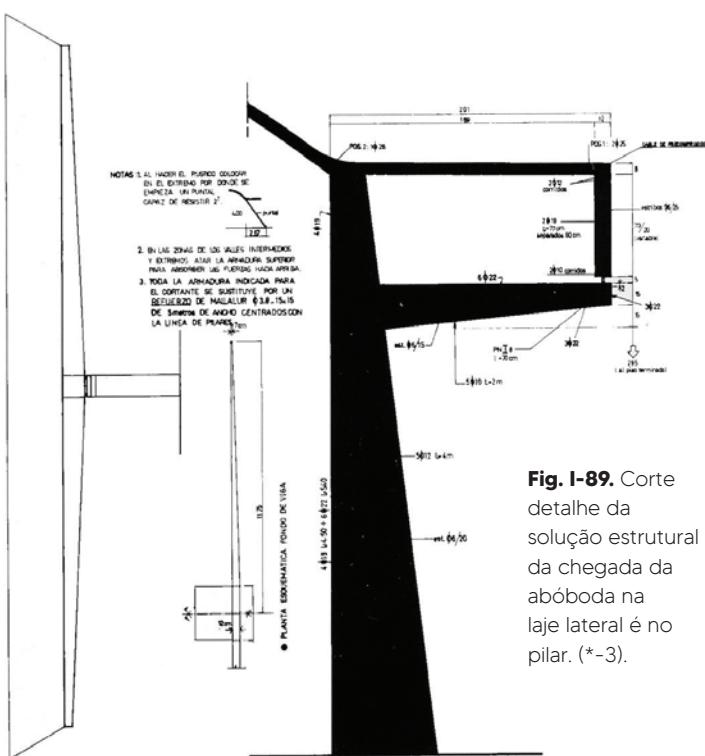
Corte detalhe da solução estrutural da chegada da abóboda na laje lateral é no pilar. (*-3).
